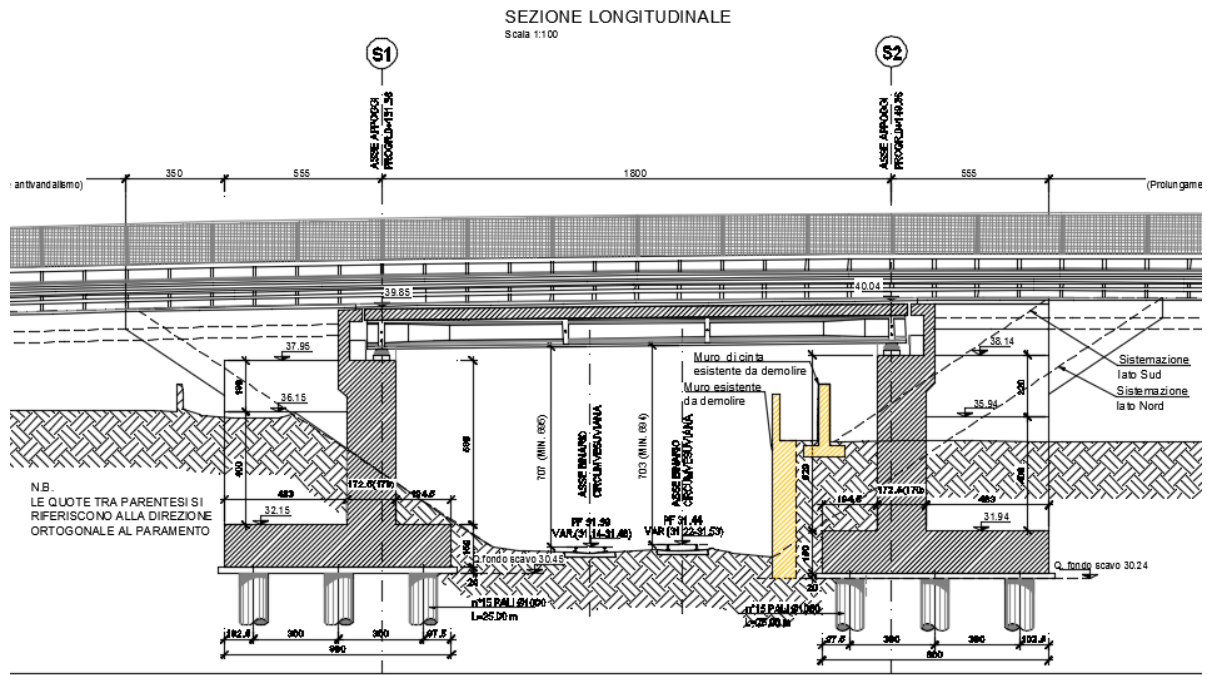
Sezione longitudinale dell'opera di scavalco IV01
